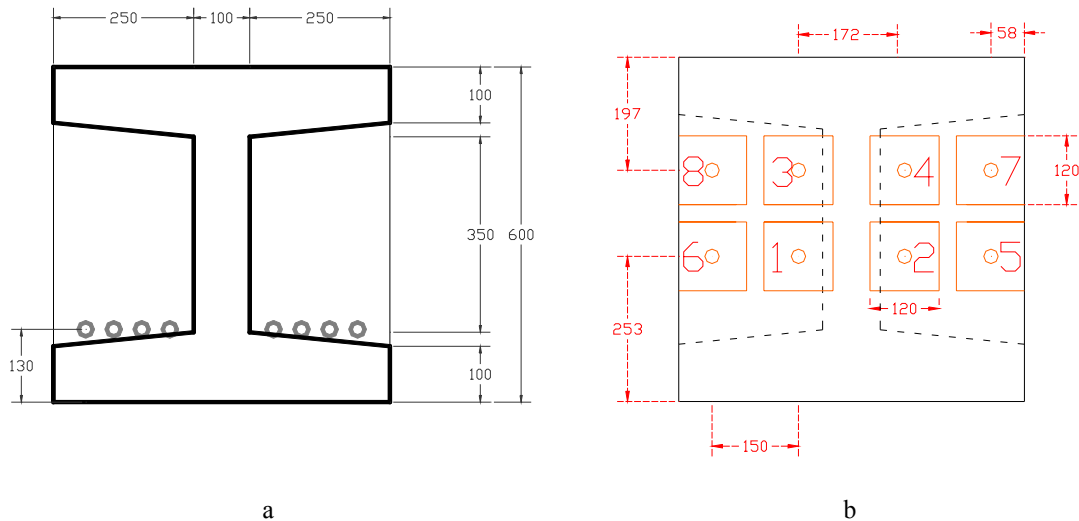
Sección transversal de las vigas en zona de centro luz y en zona de anclajes. Dimensiones en mm.
